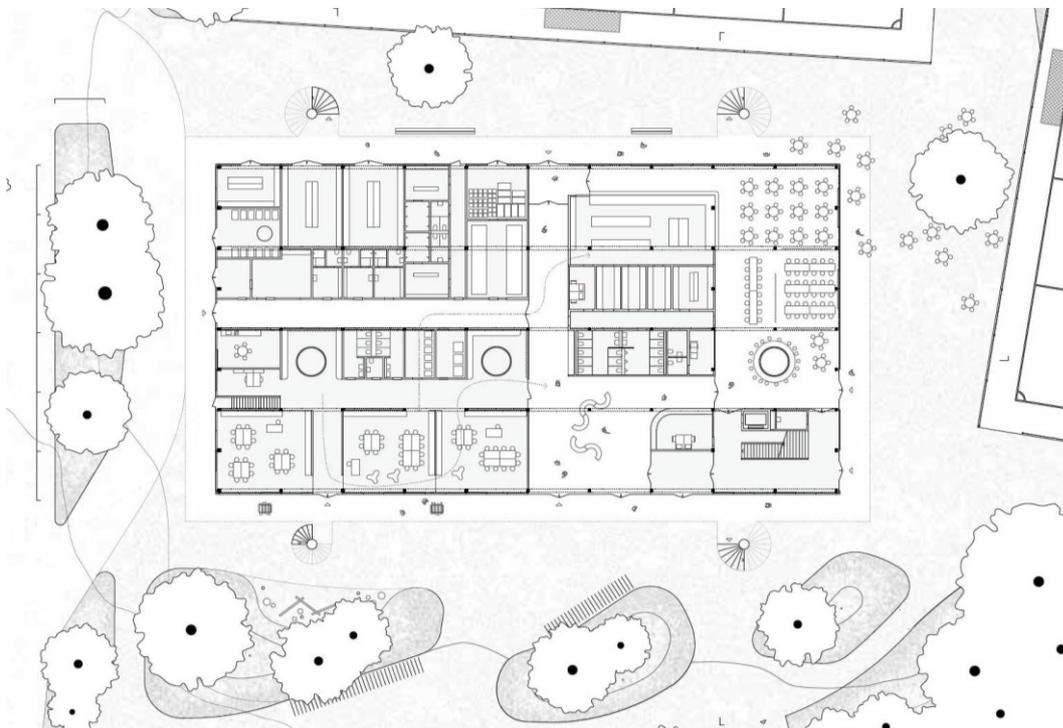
Grundriss EG Siegerprojekt mit Garderoben, Betreuung und Gastronomiebereich
